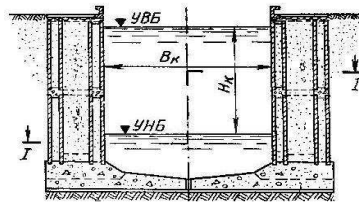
Железобетонная камера шлюза без продольных водопроводных галерей с ячеистыми стенами и разрезным дном
